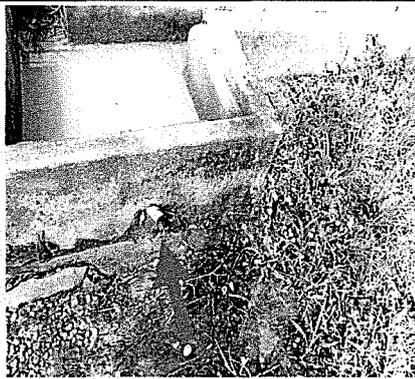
E349083 N9681478 (PSAD 56) / Locación del pozo Tambo 01.
